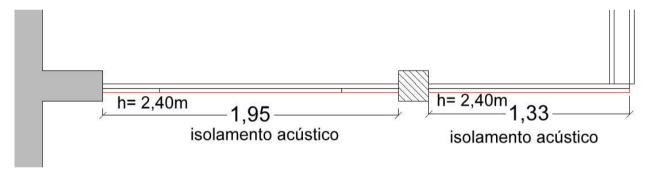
Item 3 - Planta baixa com destaque nas cotas de isolamento acústico.
